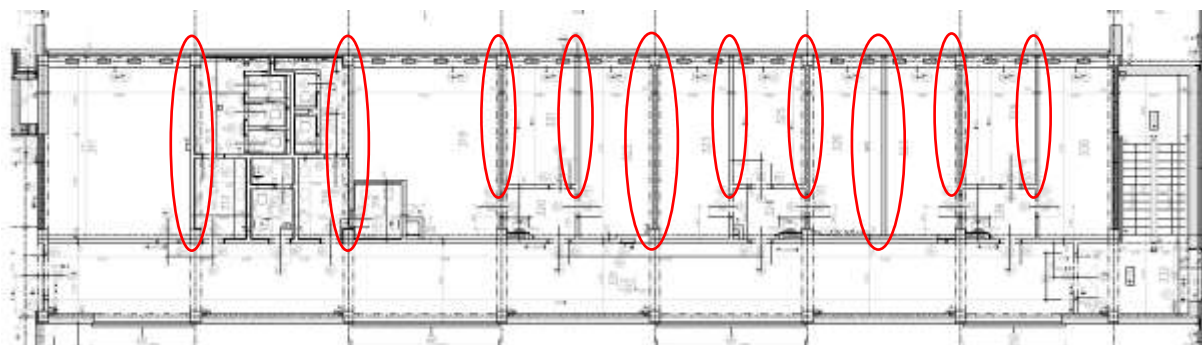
Půdorys 2. NP pavilonu „I“ se zaznačením analyzovaných konstrukcí. Zdroj [18].
